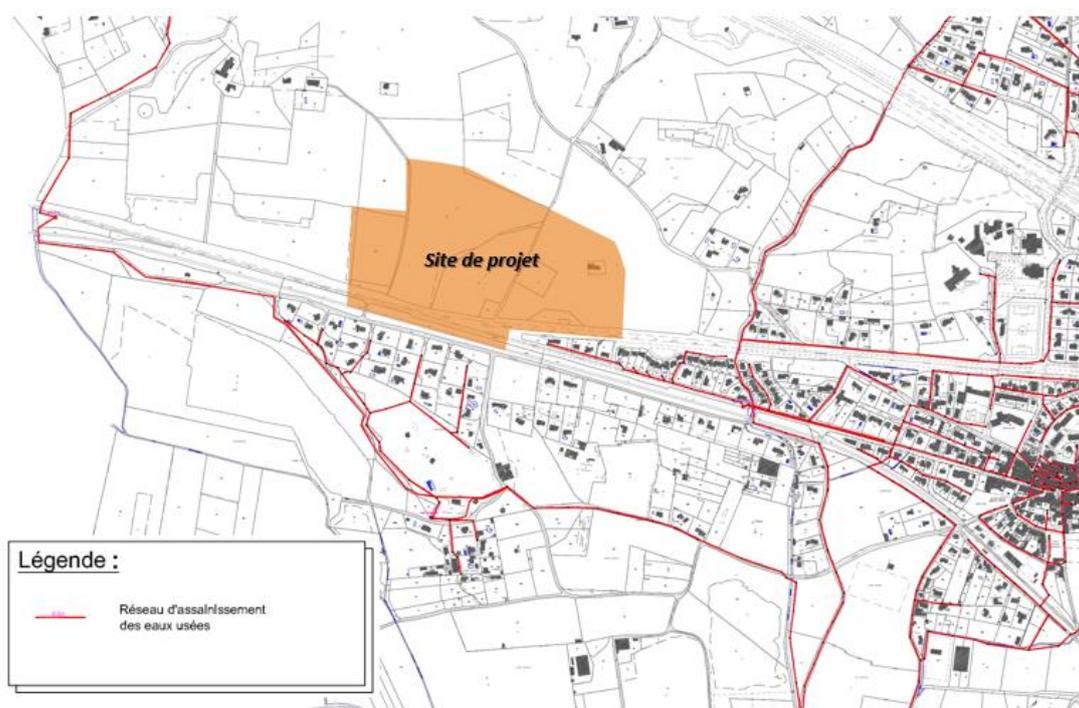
Canalisations d'assainissement des eaux usées passant à proximité du site de projet (Source : PLU Commune de Puget-sur-Argens en vigueur approuvé le 29 avril 2021)
